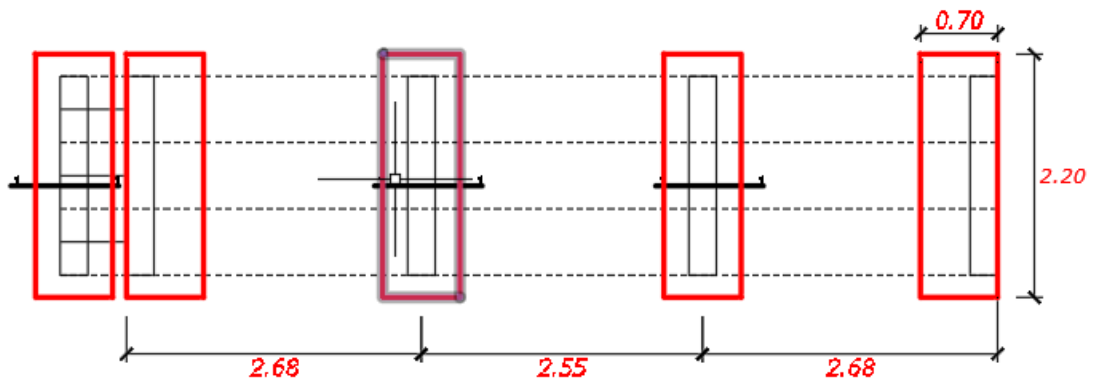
Vista de planta cimentacion de tribunas según expediente técnico
